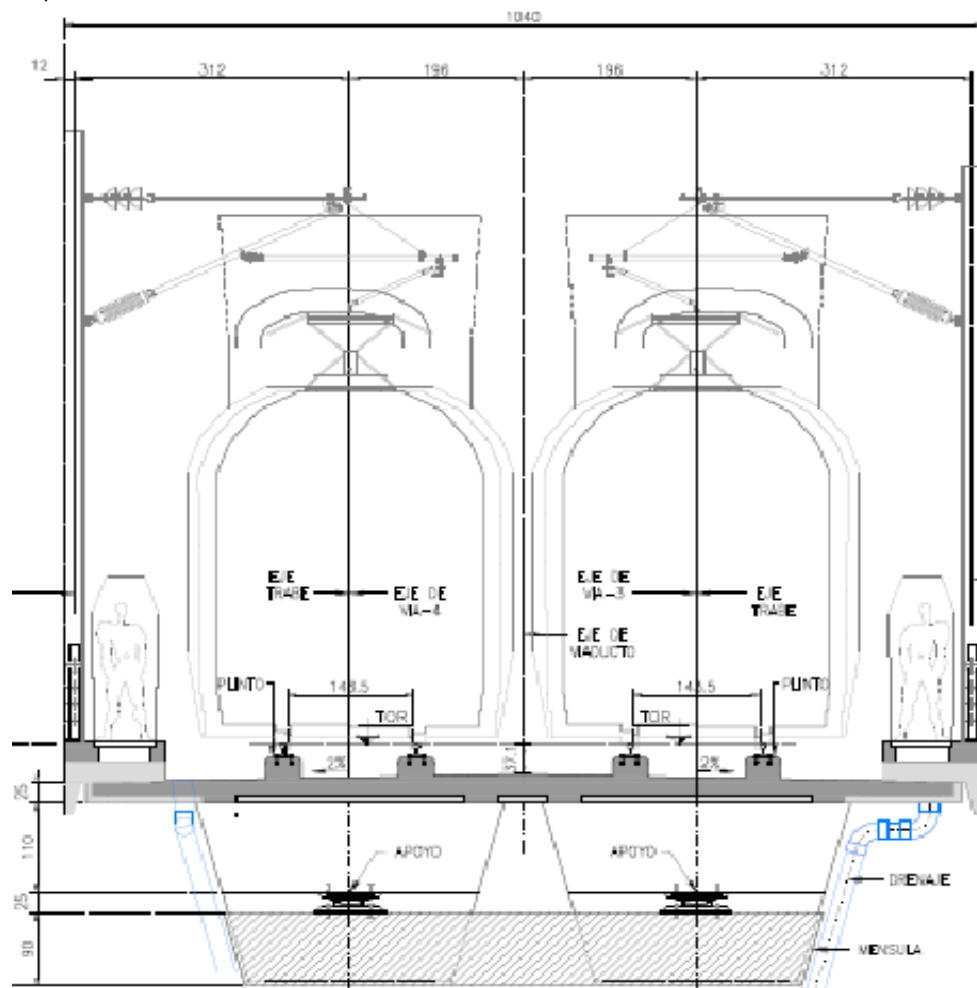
ARI Ingeniería (2023) "Sección Transversal Tipo Sobre Apoyos"
